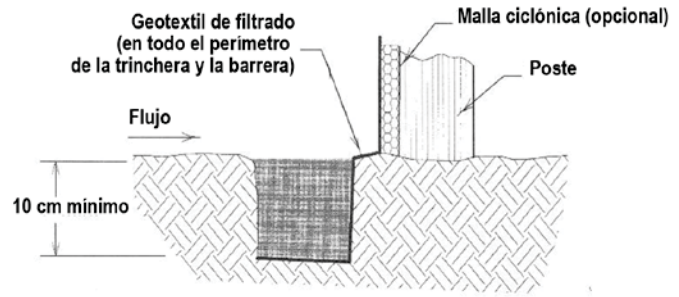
DETALLE CONSTRUCTIVO DE BARRERA DE RETENCIÓN DE AZOLVE
